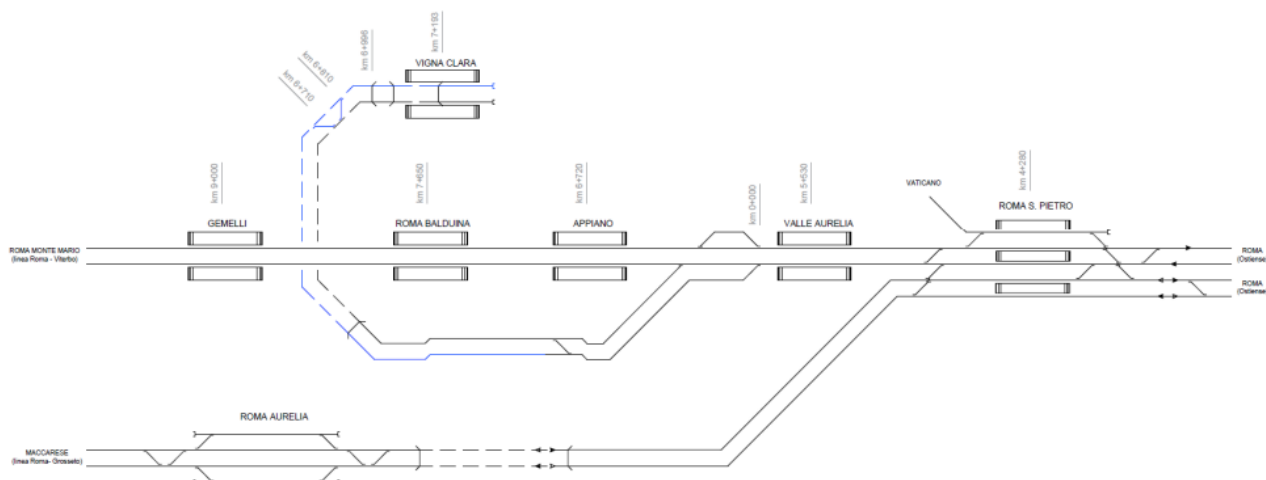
Scenario Schematico di Progetto del Lotto 1 A
